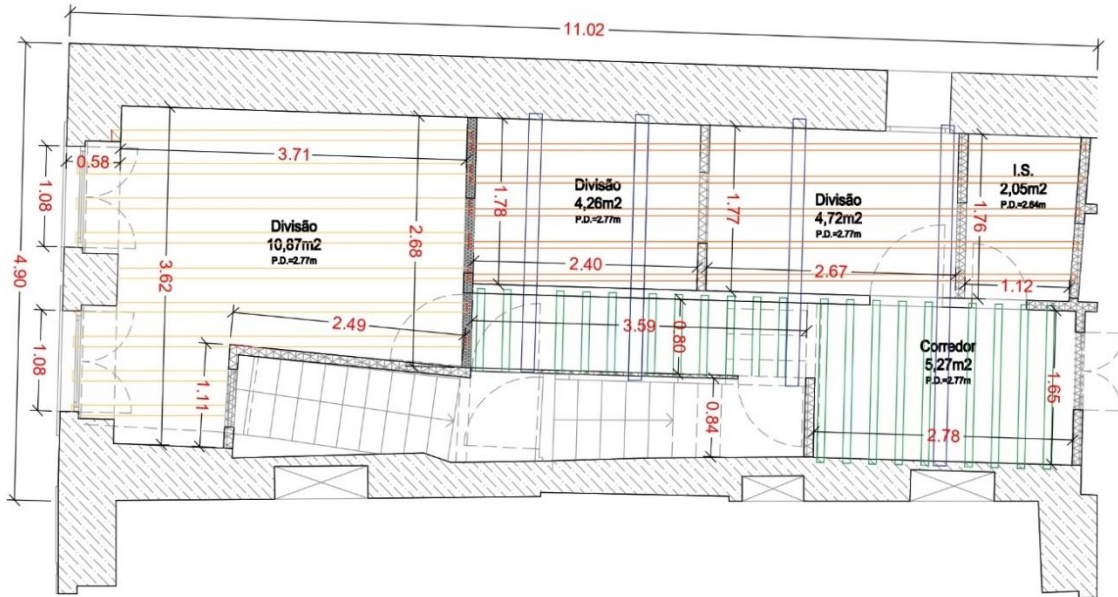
Planta estrutural do pavimento do piso 1 (Mendonça, 2023)
